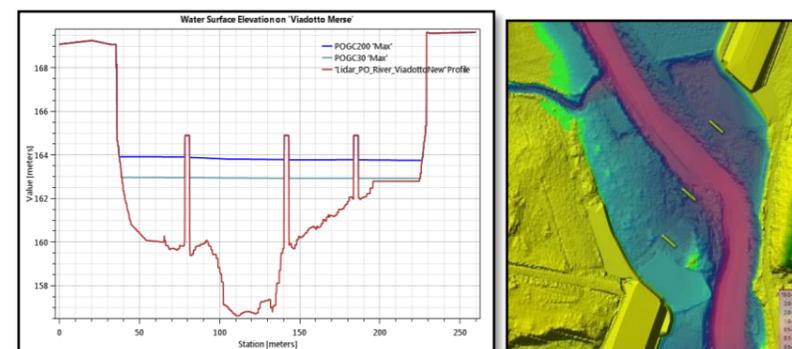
Sezione e planimetria idraulica derivante dallo studio dimensionale del corso d'acqua Merse in asse al viadotto
